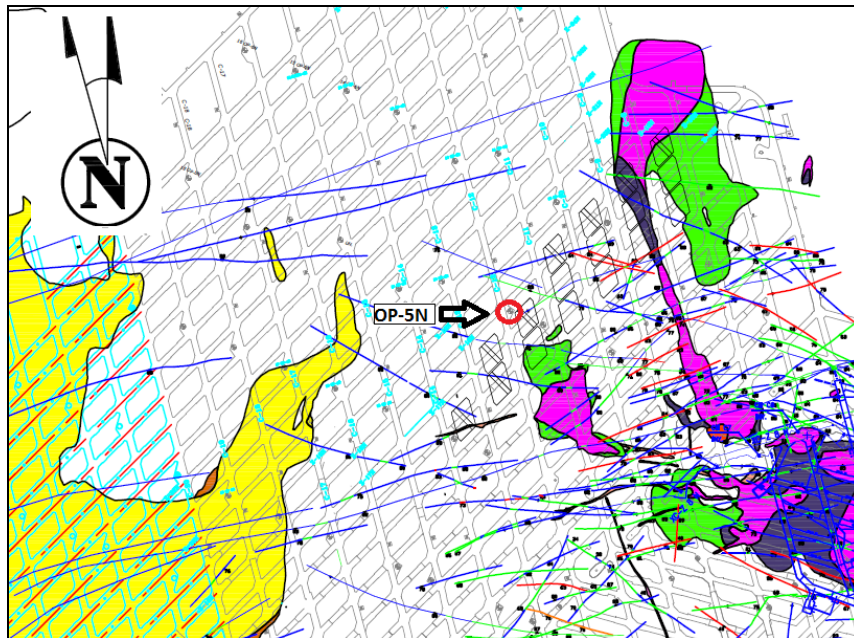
Vista en planta sector de daños, ubicación OP-5N.
